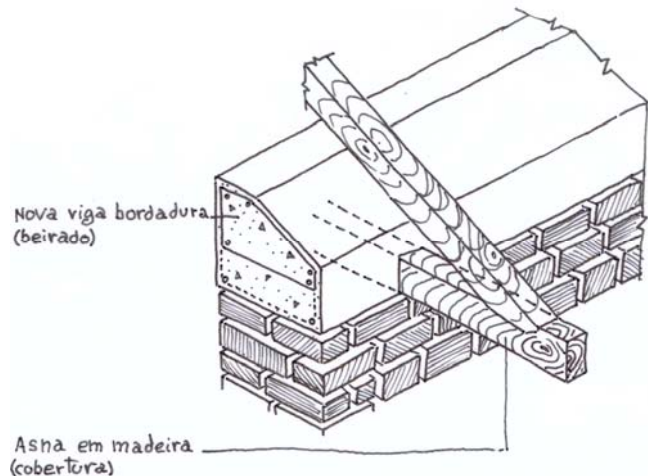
| Efeito de diafragma rígido ao nível da cobertura, por introdução de viga de coroamento em betão armado/cintado (no topo da parede), para encastramento directo de asna de madeira (adaptado de [14]):
